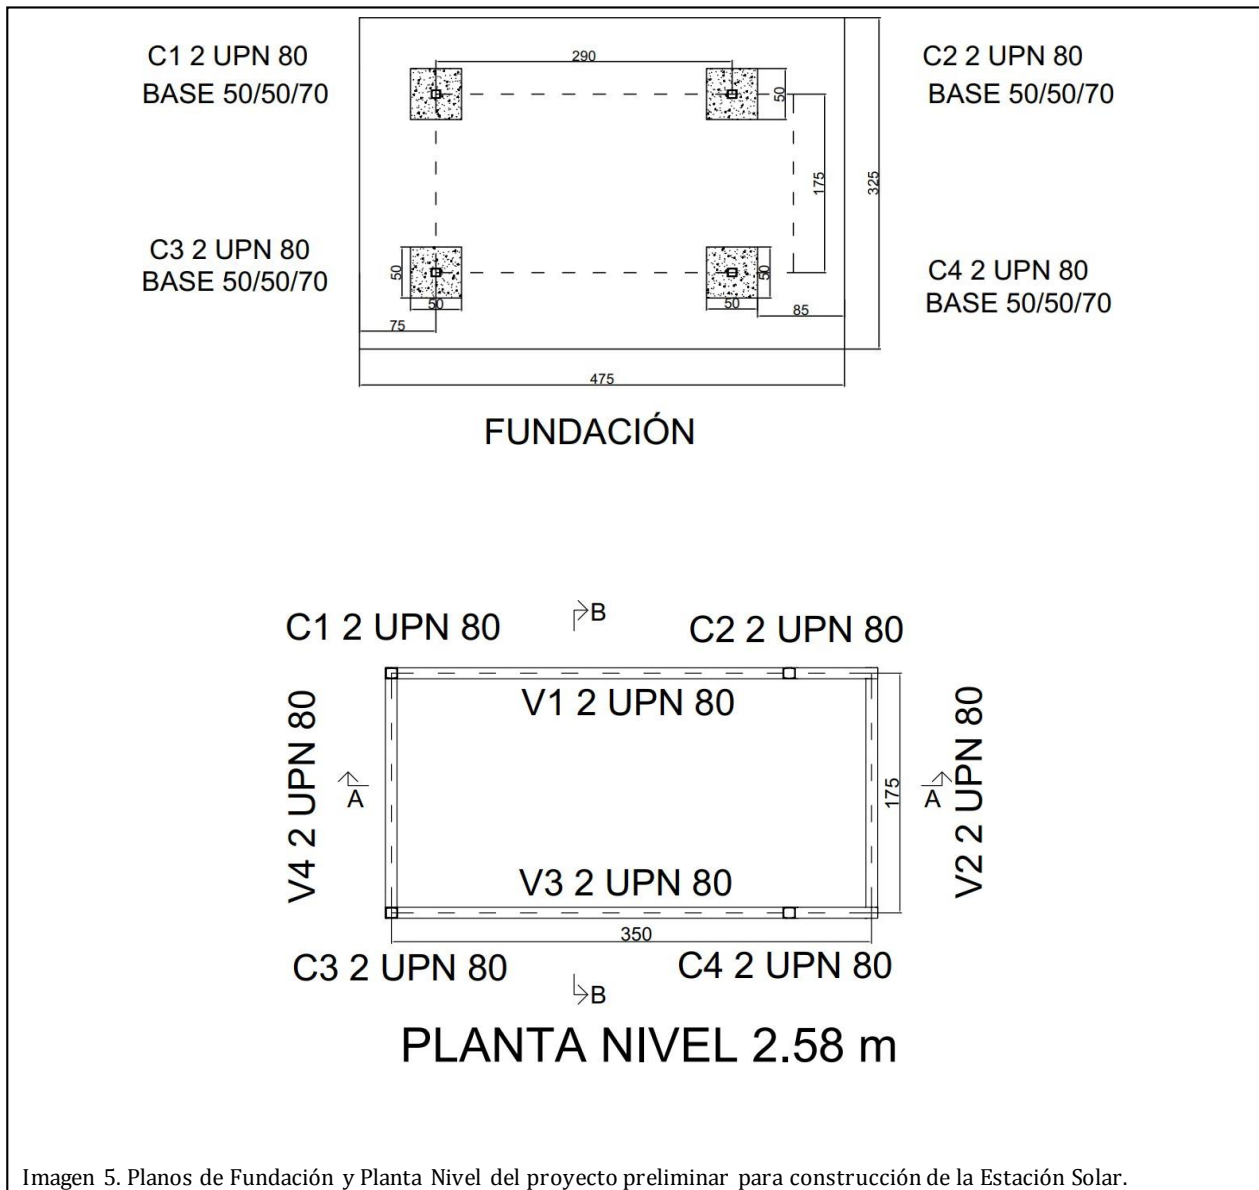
Planos de Fundación y Planta Nivel del proyecto preliminar para construcción de la Estación Solar.
